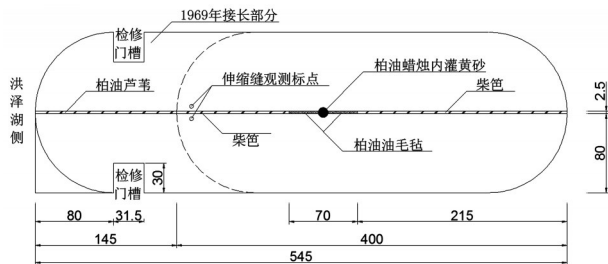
三河闸闸墩伸缩缝结构平面图(单位:cm)
